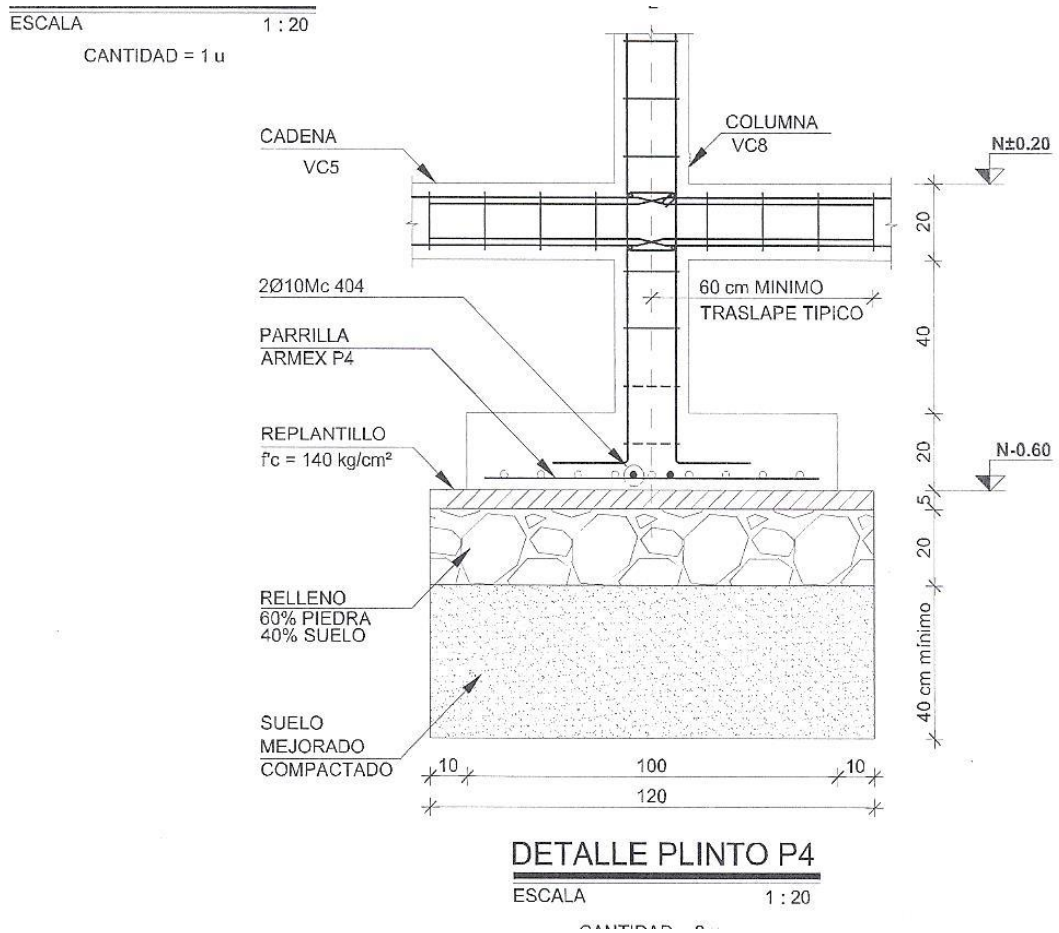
Detalle de Plinto utilizado para la cimentación
